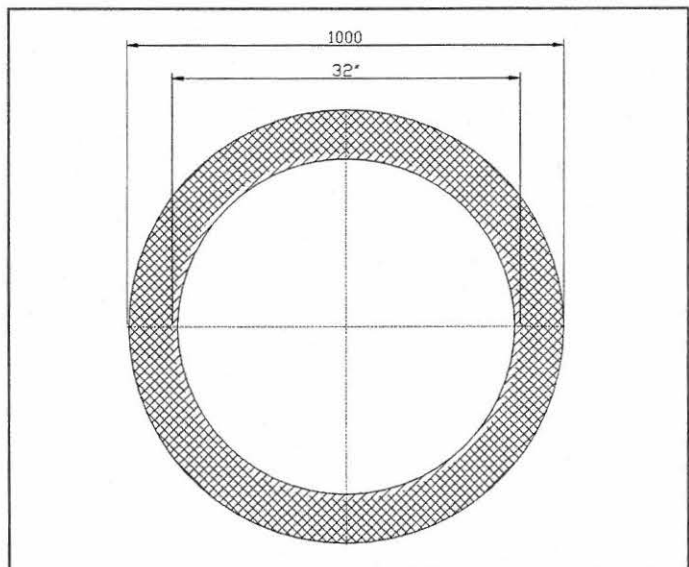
Rohrleitungsisolierung: Aufbau der Isolierung: Mineralwolle 100 mm, Stahlblech 1 mm entdröhnt
